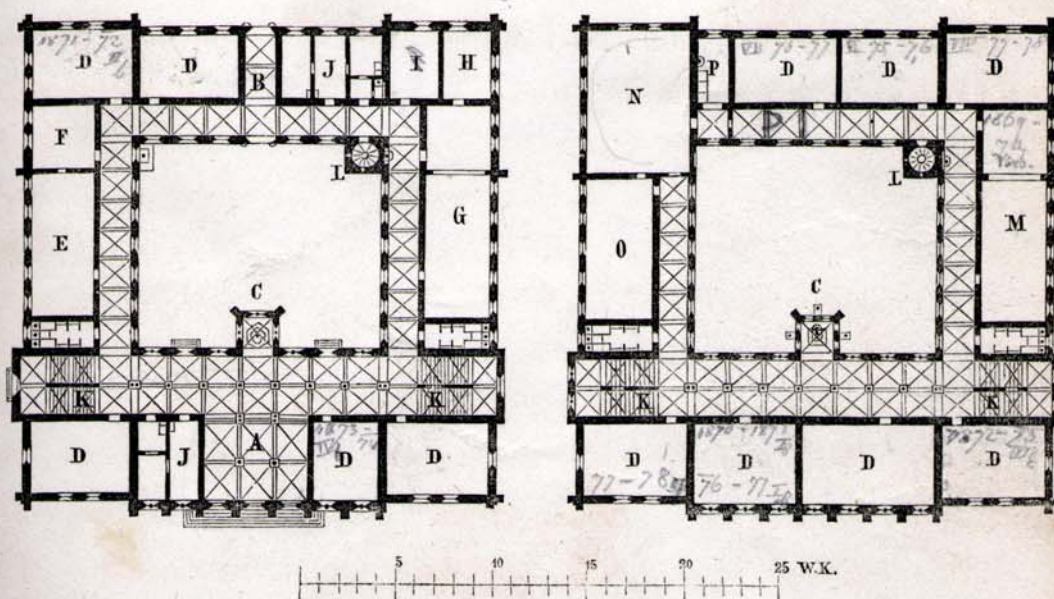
Akademisches Gymnasium: Grundriss
